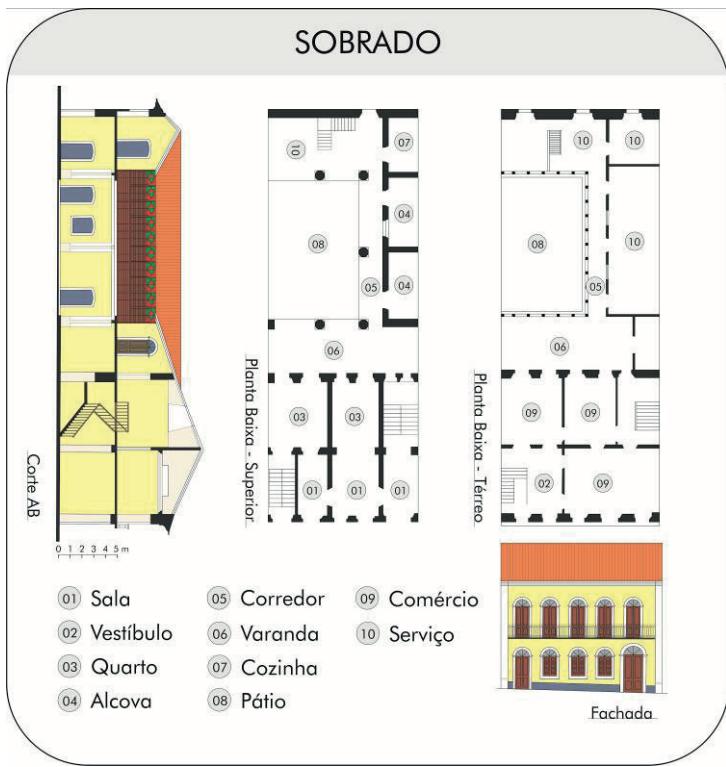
Desenho esquemático da fachada, corte e plantas baixas de um sobrado. Fonte: Adaptado de Silva Filho, (1998).
